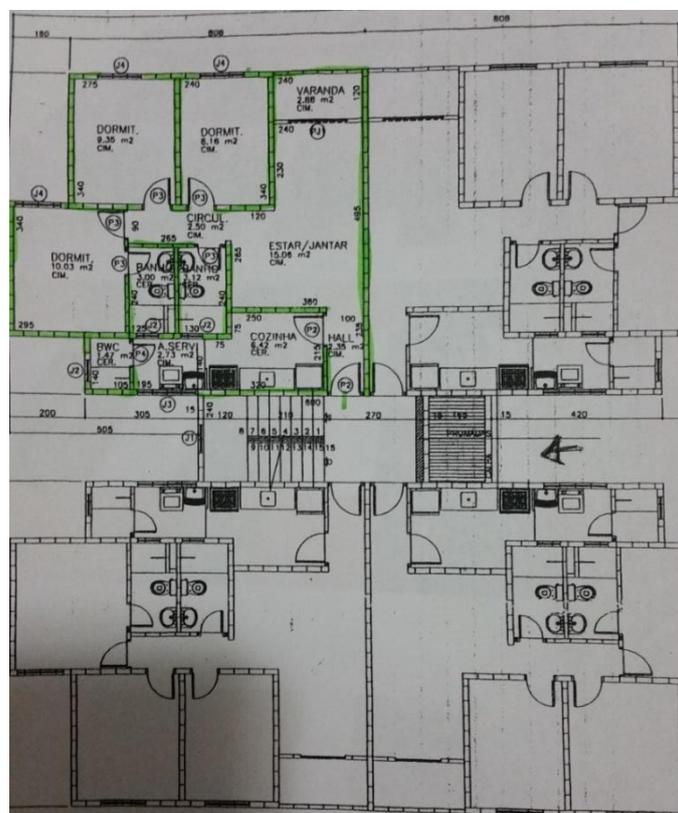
Planta do projeto do Edifício Residencial Y.
